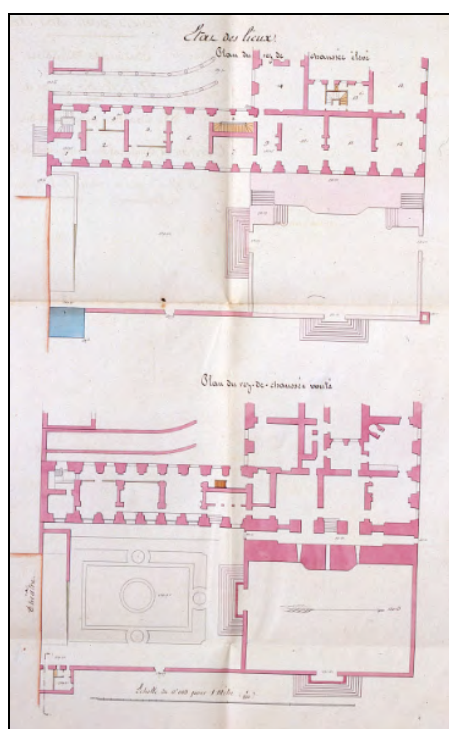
« Projets pour 1864-1865 – Bâtiments militaires (...) Améliorations au logement du Général de Division », « Etat des lieux : Plan du rez-de-chaussée élevé et plan du rez-de-chaussée voûté », 1863, Service Historique de l'Armée de Terre, Plans article 8, détail de l'état existant ©Région Lorraine - Inventaire Général
